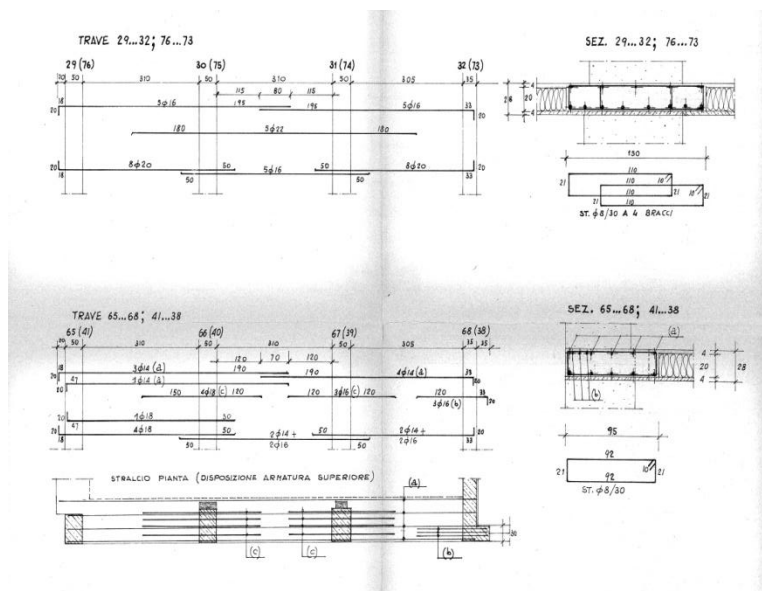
Estratto tavola 95/s, armatura travi di copertura 1°-2°-3°-4° piano
